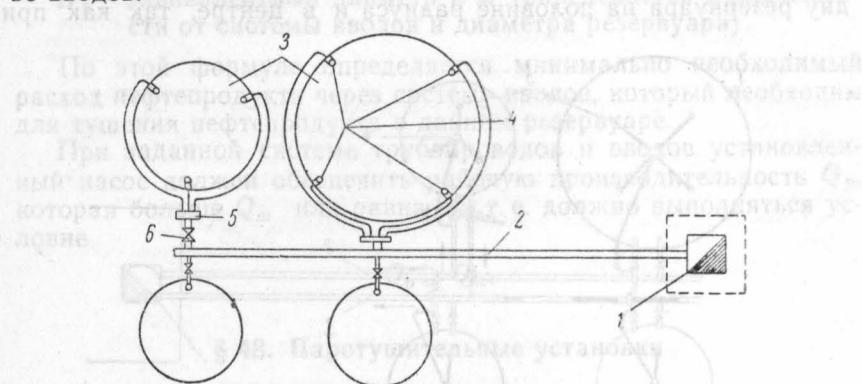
Схема тушения методом перемешивания сжатого воздуха
